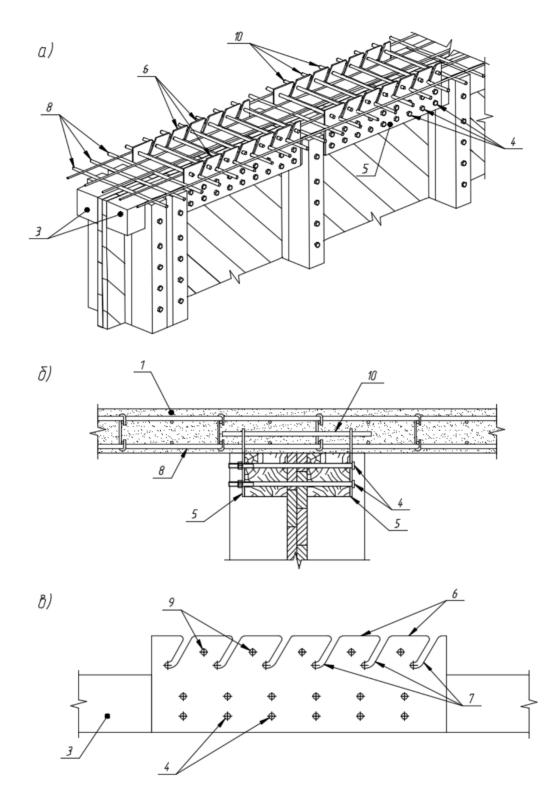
Конструкция узла №1 объединения железобетонной плиты и ДГБ: а – изометрический вид (железобетонная плита не показана); б – конструкция объединения совместно с железобетонной плитой; в – конструкция стыковой гребенчатой накладки
